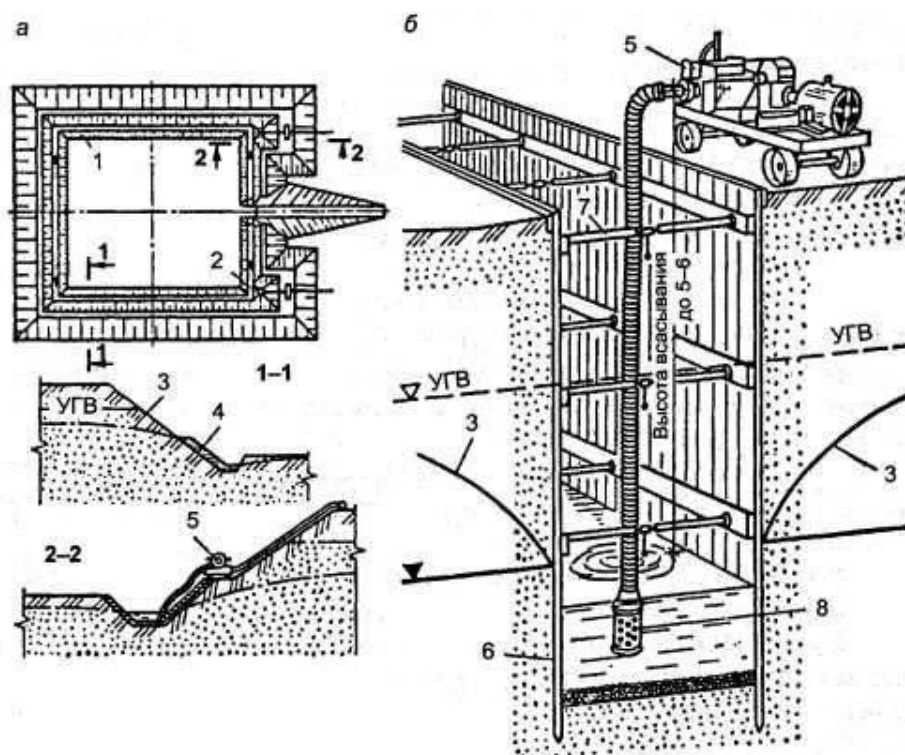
Открытый водоотлив из котлована (а) и траншеи (б): 1 - дренажная канава; 2 - приемок (зумпф); 3 - пониженный уровень грунтовых вод; 4 - дренажная пригрузка; 5 - насос; 6 - шпунтовое крепление; 7 - инвентарные распорки; 8 - всасывающий рукав с сеткой (фильтром).
